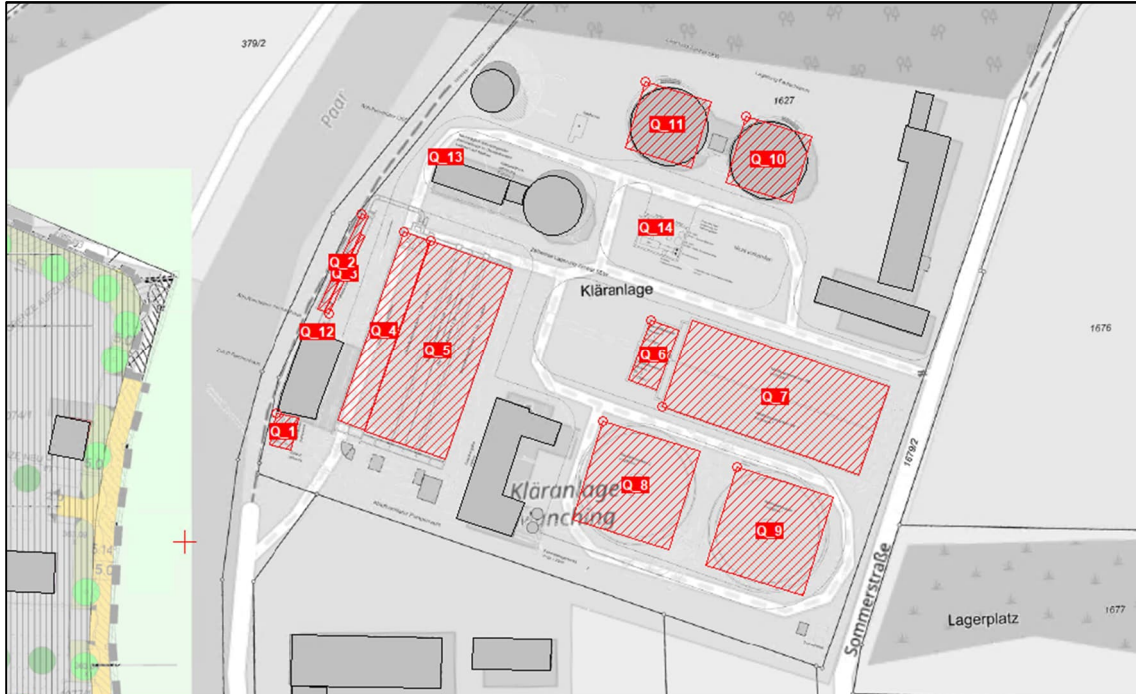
Lageplan mit Darstellung der modellierten Quellen
